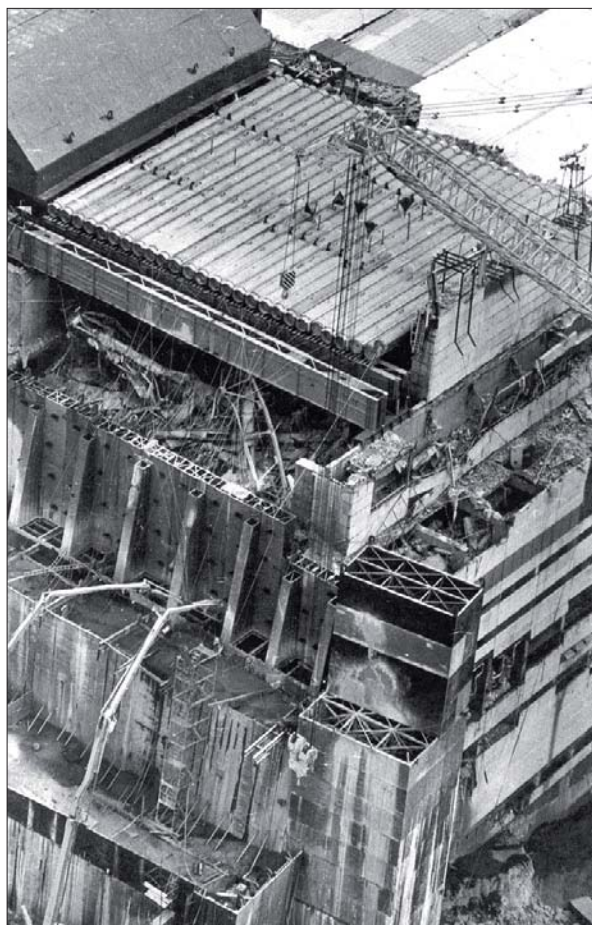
Строительство «Укрытия». Идет заливка бетоном уступов каскадной стены с помощью специальной дистанционной техники. Центральный зал перекрыт трубным накатом, лежащем на балках Б1 и Б2
